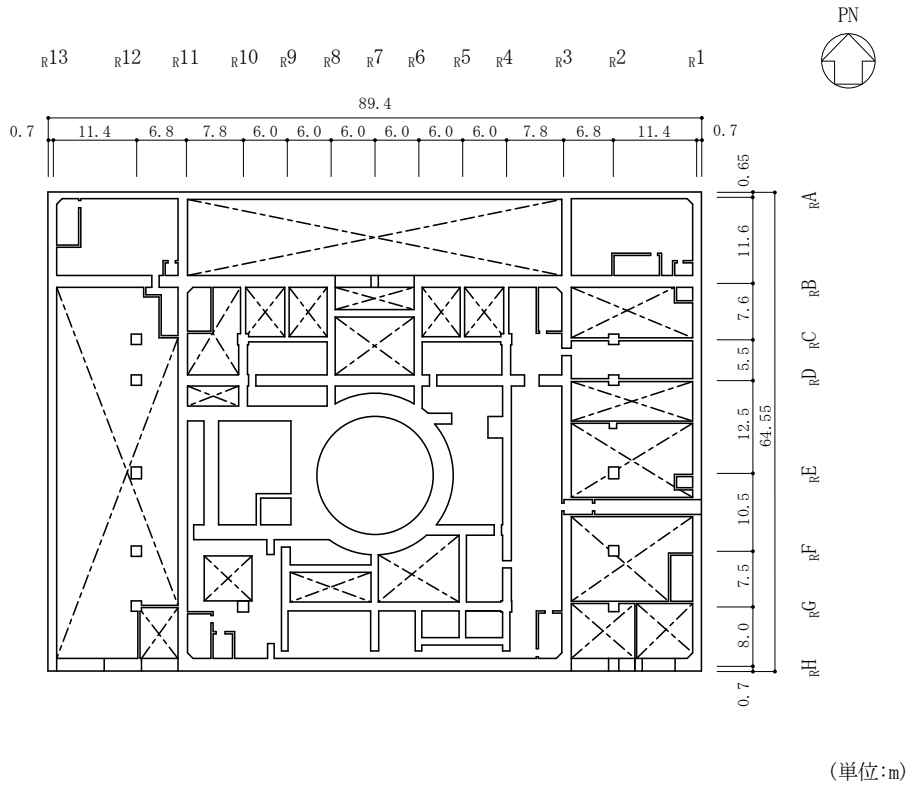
(5) 原子炉建物の概略平面図 (EL 30.5m)
